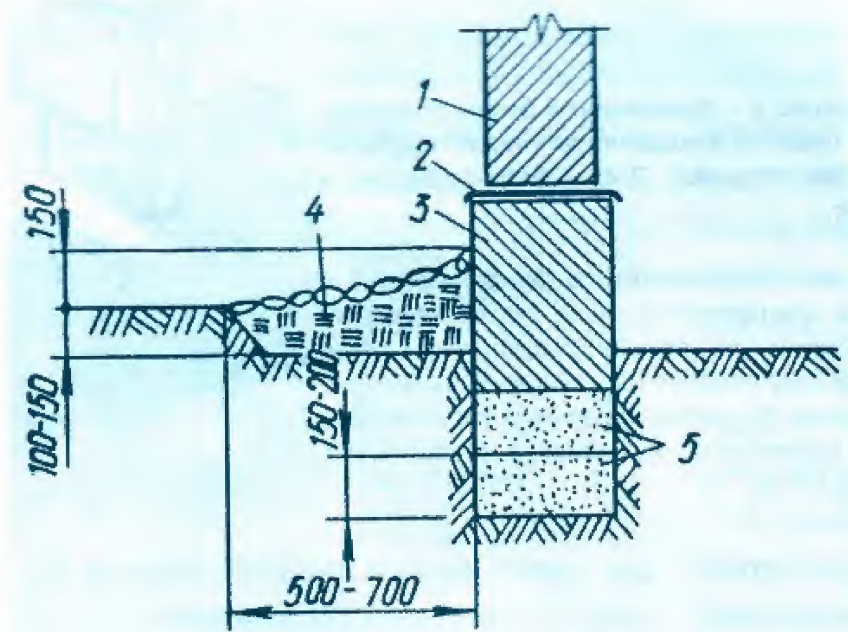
Схема кам'яного (цегляного) фундаменту з подушкою: 1 – стіна; 2 – горизонтальна гідроізоляція; 3 – кладка фундаменту; 4 – вимощення; 5 – подушка.
